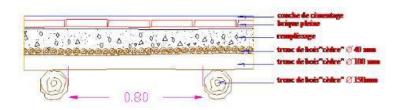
montrant une coupe schématique d'un plancher traditionnel, source : PPSMVSS, 2017.
